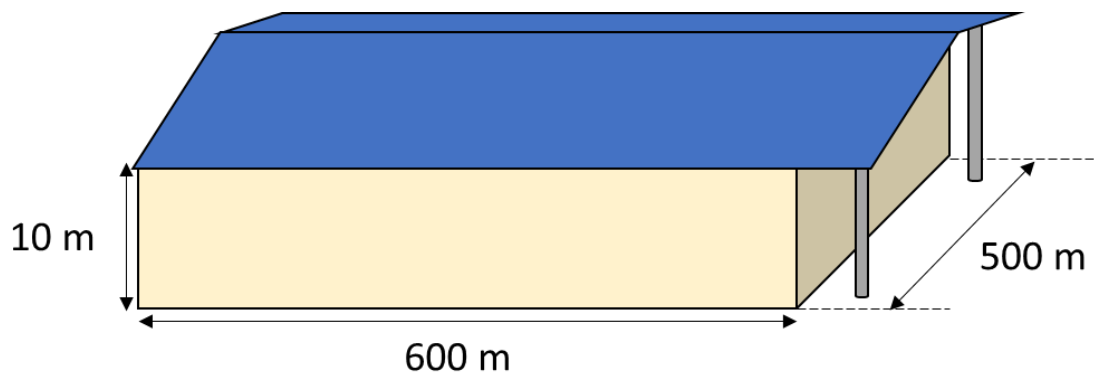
Plano infraestructura planta de tratamiento (Fuente: Elaboración propia)
